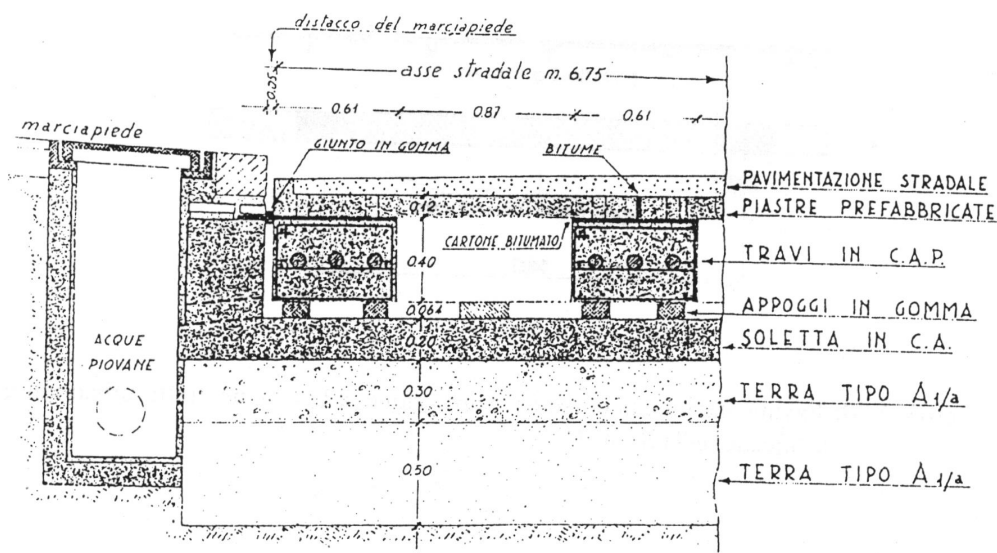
Sezione del pacchetto stradale realizzato nel 1970 per la protezione del palazzo della Farnesina⁴⁶
